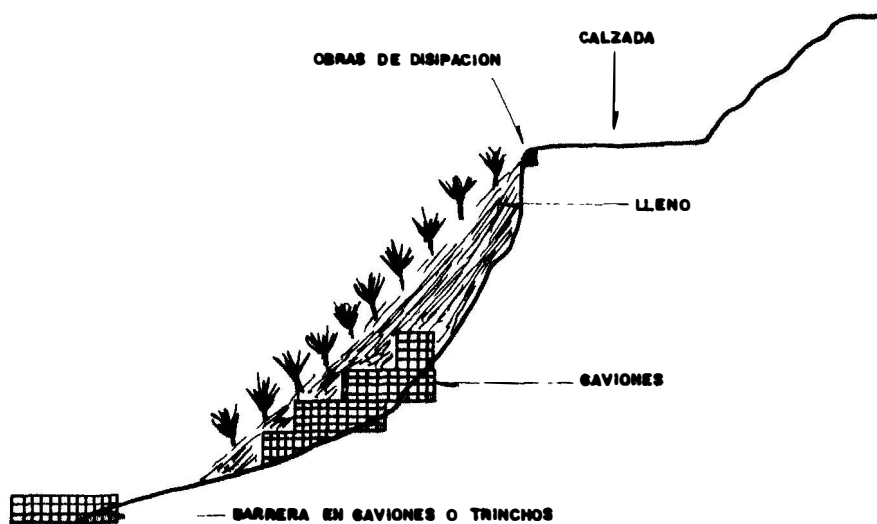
PROPUESTA DE ESTABILIZACION DEL TALUD INFERIOR DE LA CARRETERA A LA ALTURA DEL CAÑO NORTE DEL HOGAR INFANTIL LAS COLONDRINAS.
